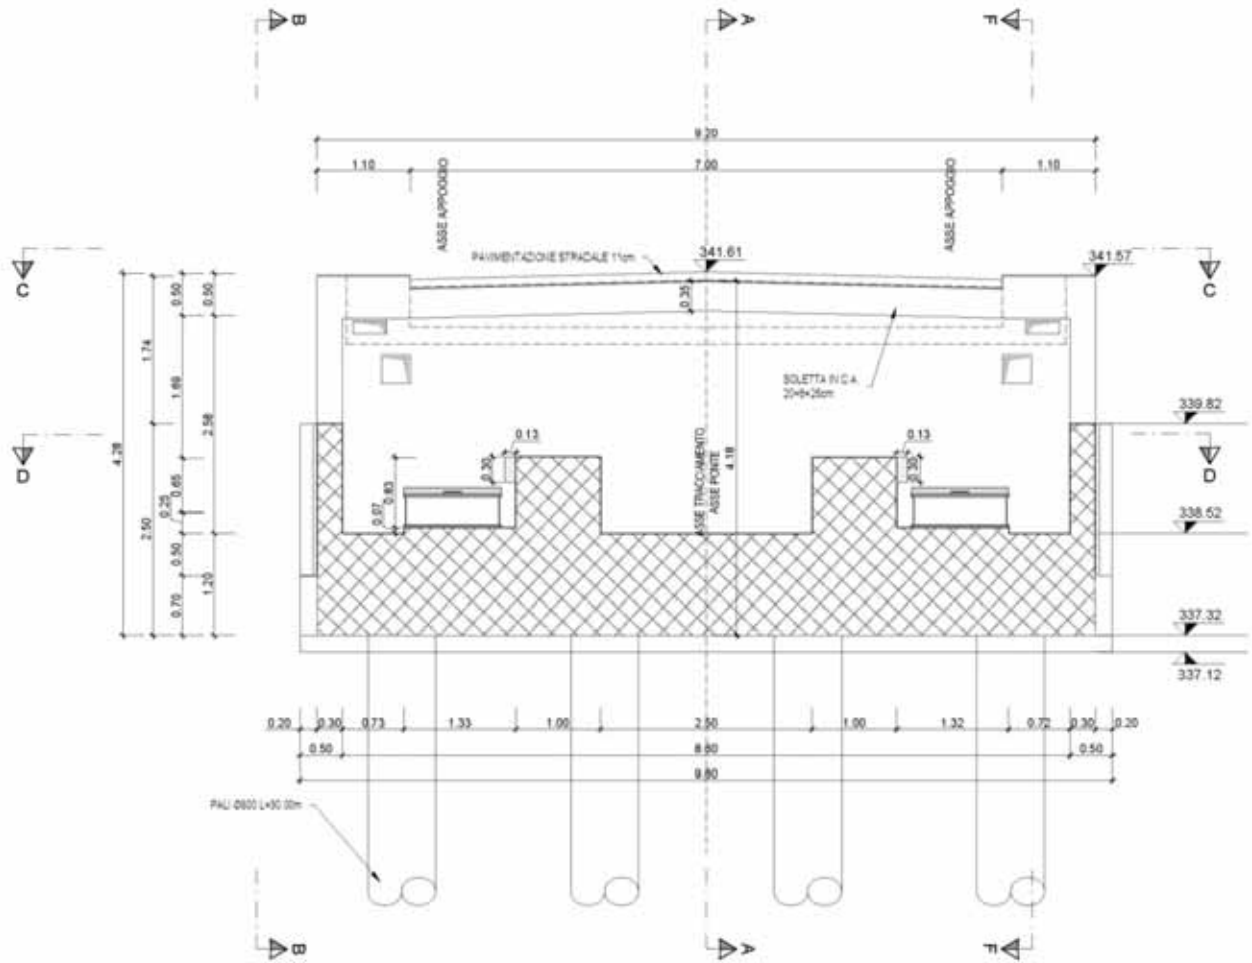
SPALLA A – Sezione longitudinale
